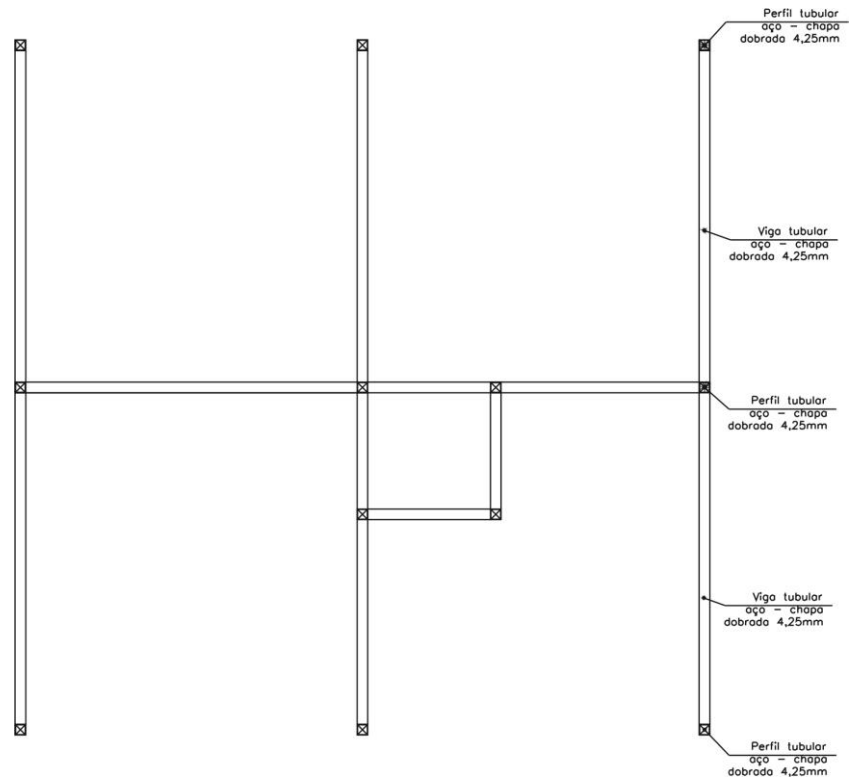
Planta com modulação de pilares e vigas – Modelo arquitetônico 34,69 m².
